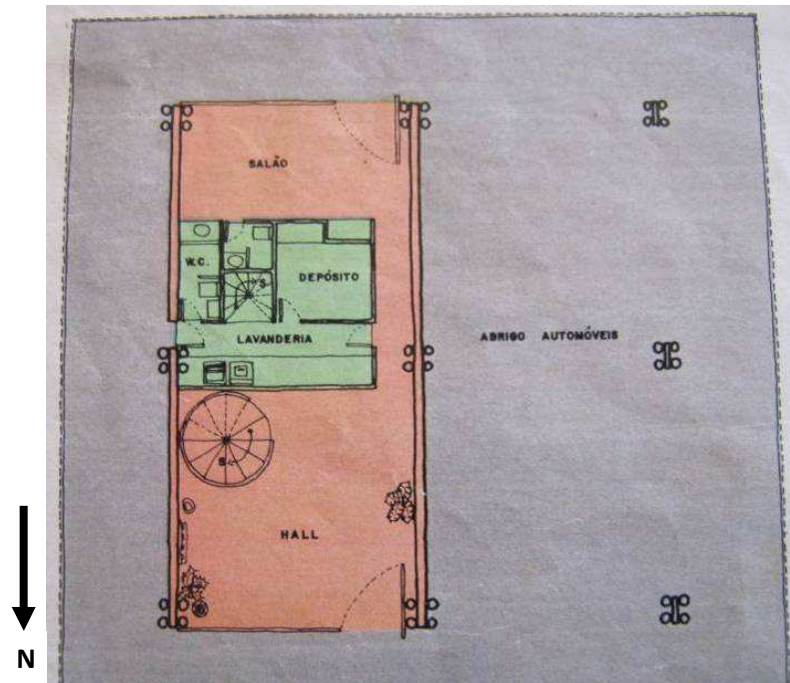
Residência Abraão Assad*: planta esquemática do pavimento térreo.
